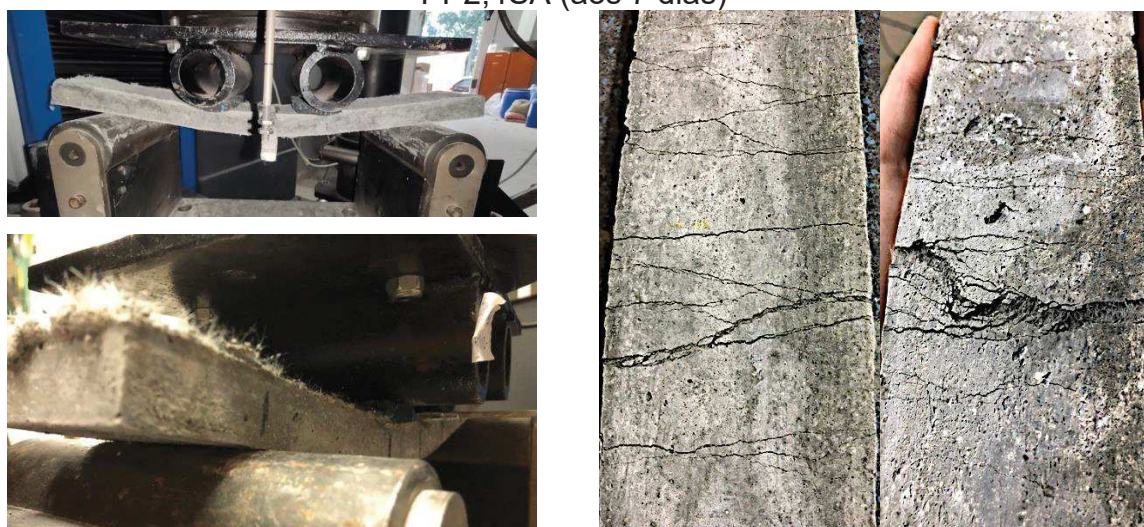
Padrão de fissuração das amostras após ensaio de tração na flexão
